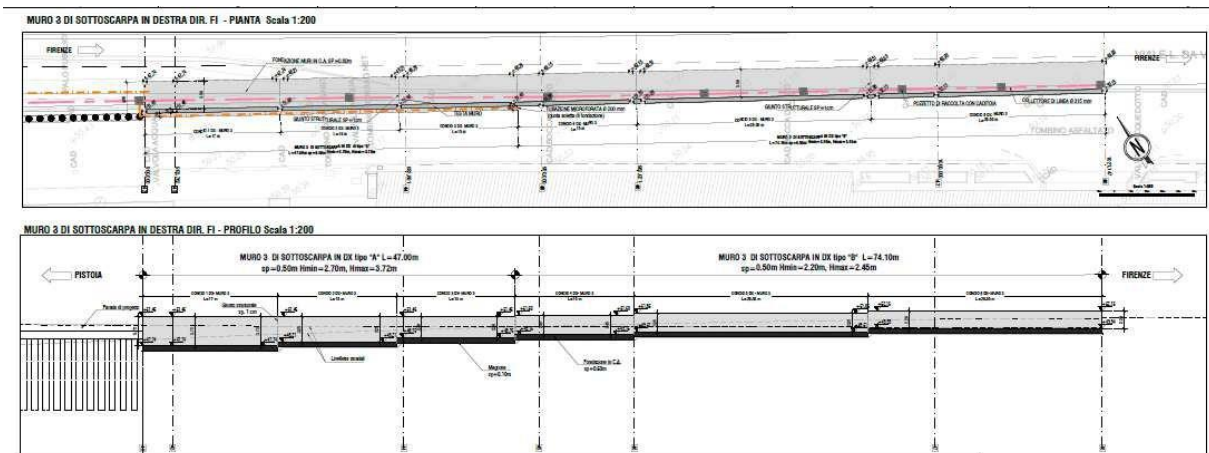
Stralcio planimetrico e prospetto muri di sottoscarpa 3 asse dx in direzione Firenze
